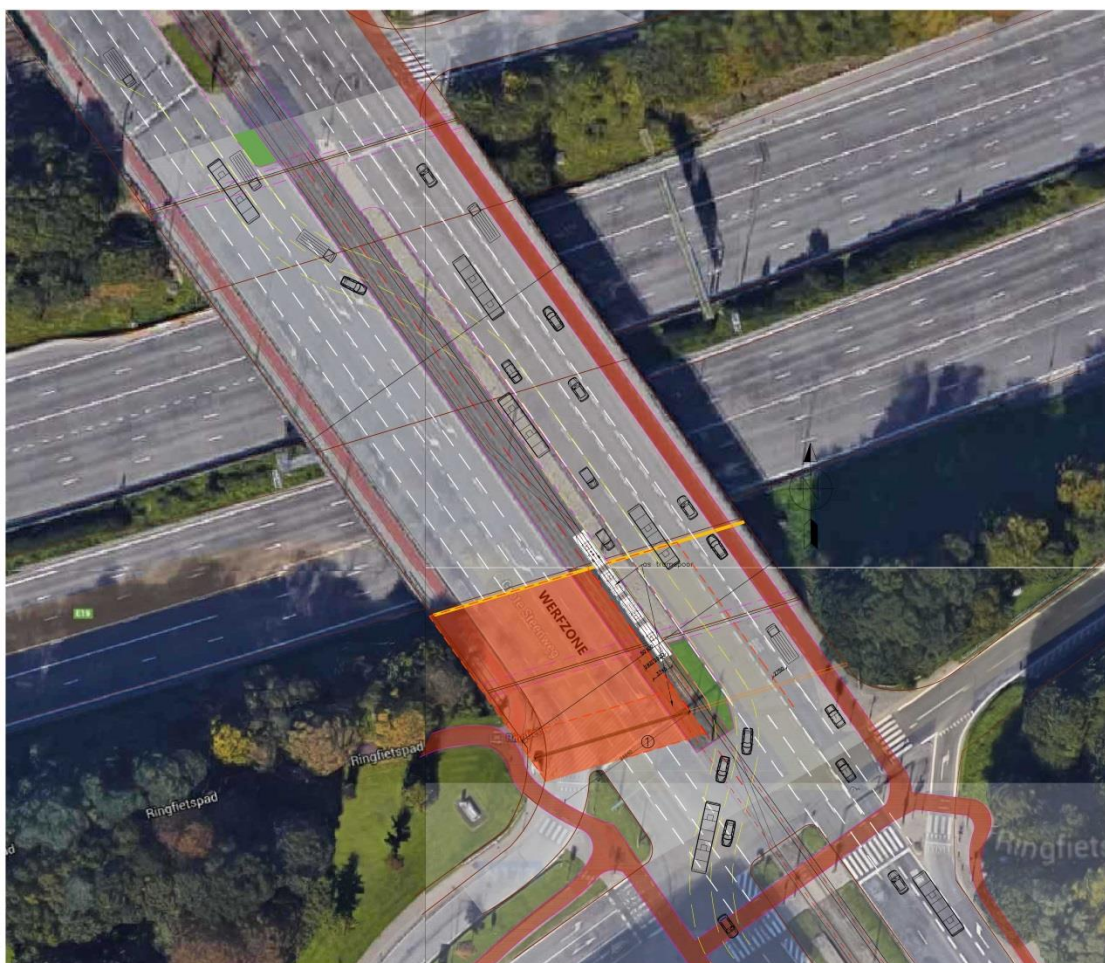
bovenzicht brug Grote Steenweg fase 1: uitvoering wand en verlengen brugdeel zijde richting periferie, alle verkeer over 1 zijde (richting centrum)
